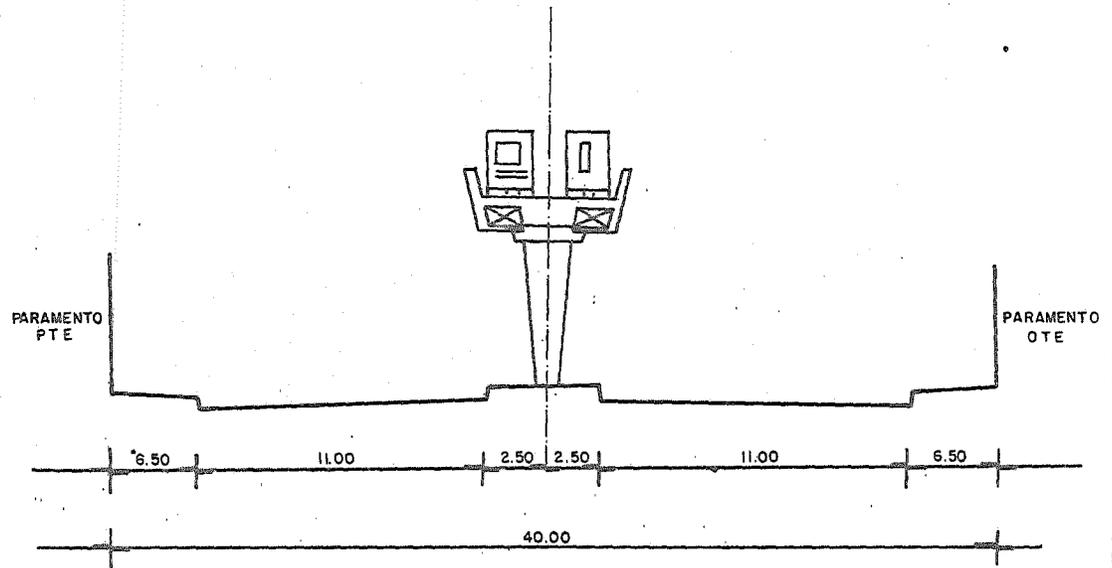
SECCION TRANSVERSAL TIPICA SOBRE AV. IMPRENTA
